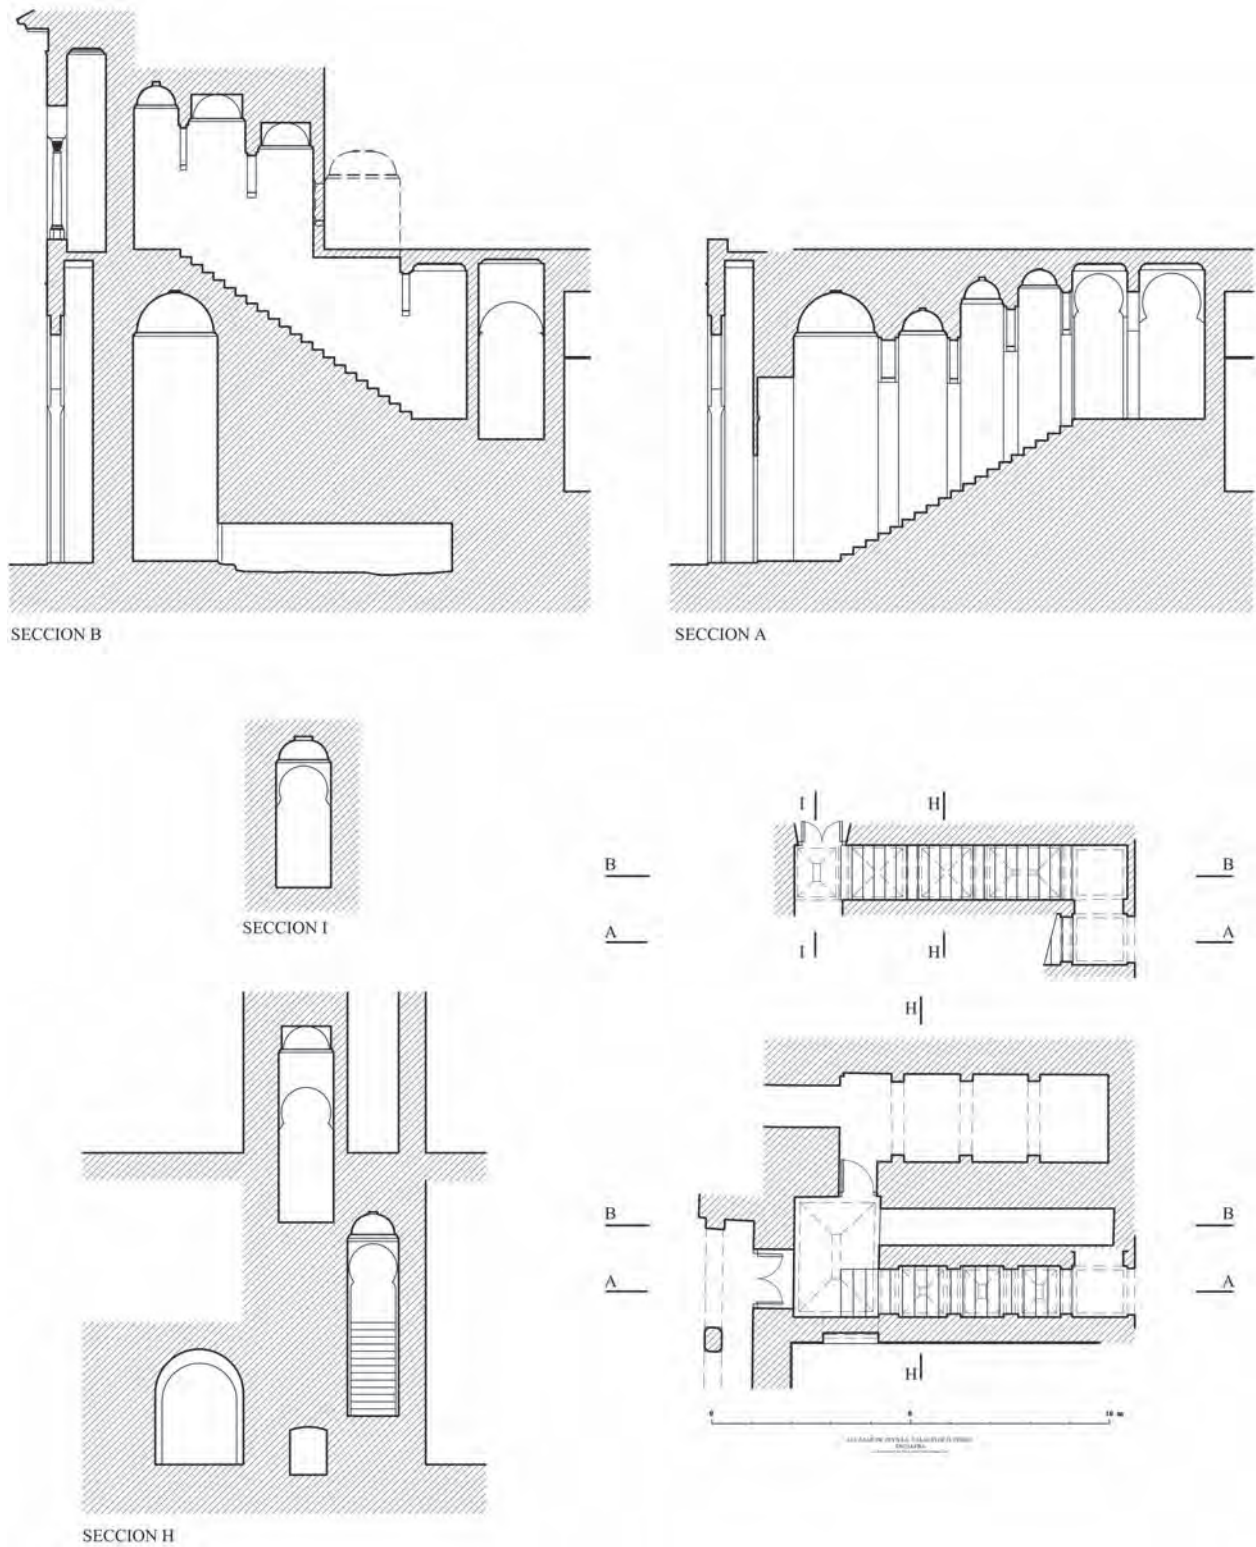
Planta y secciones de la escalera pública (A. Almagro).
